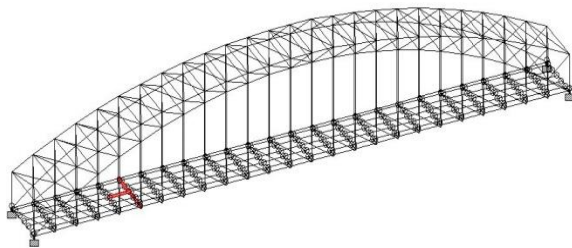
Potongan Memaanjaang Jembatan Pre Elemniary Alternatif Design
